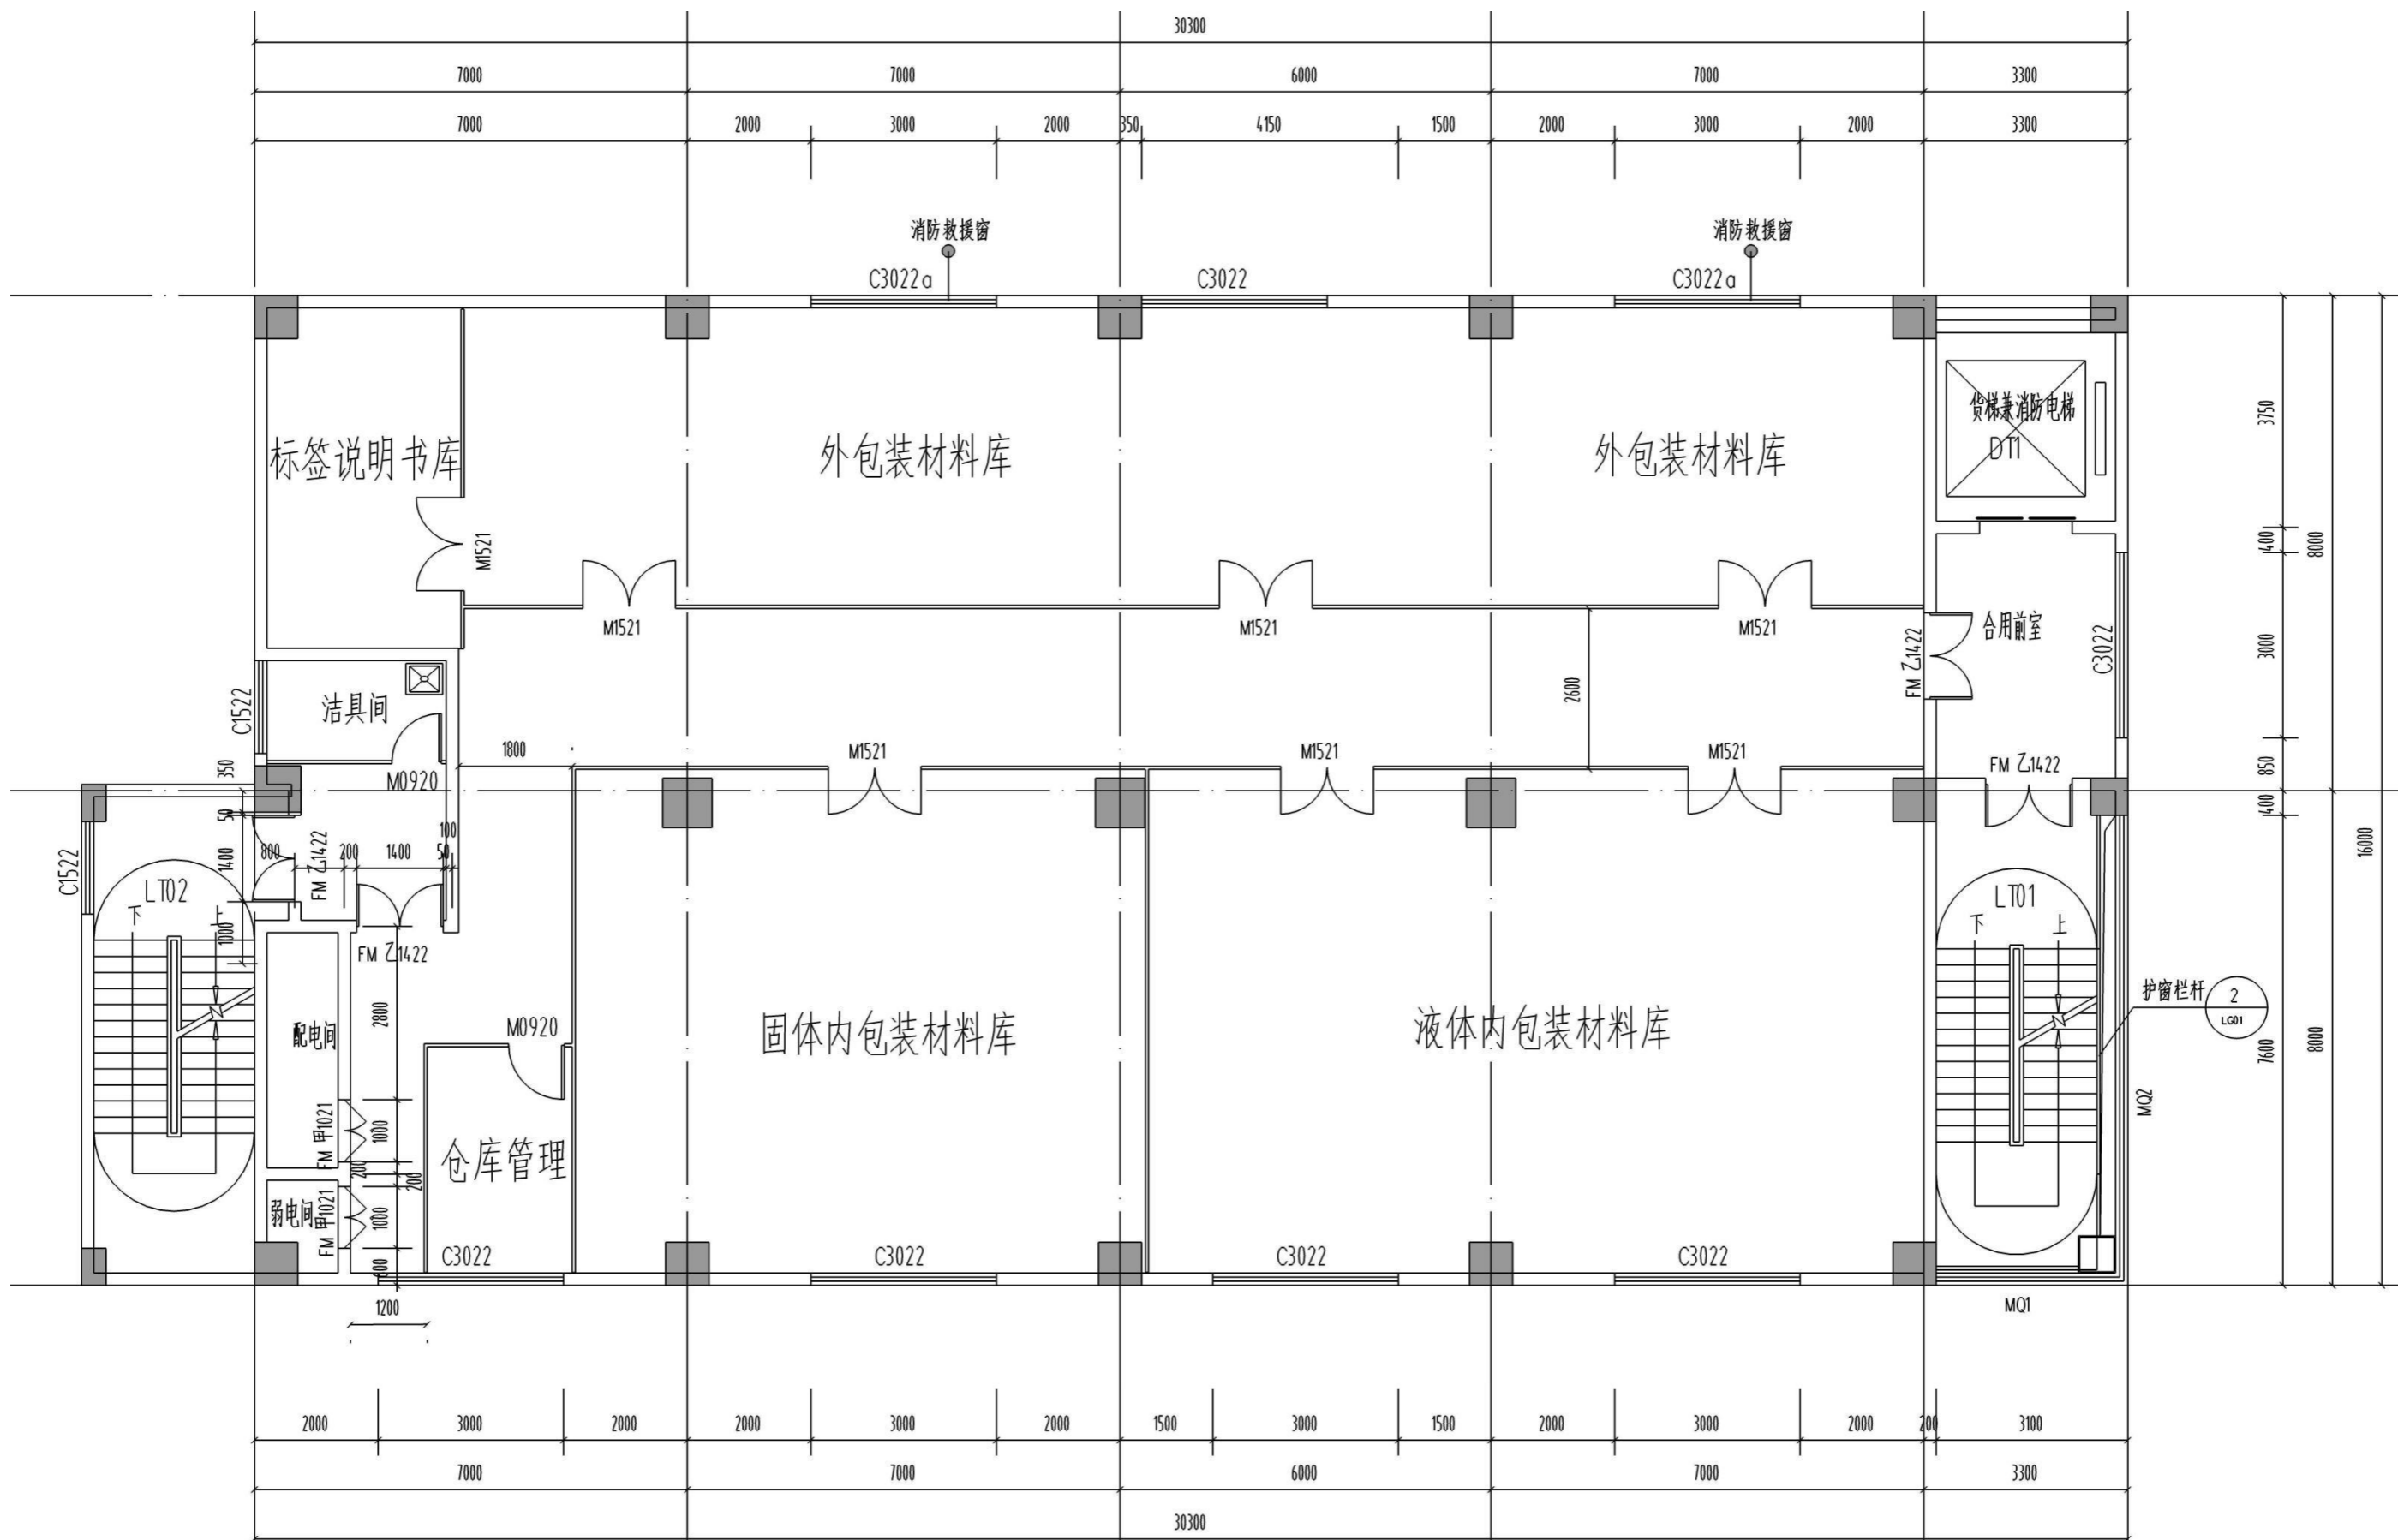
八层（包装材料仓库）平面布置图（比例尺 1:100）
